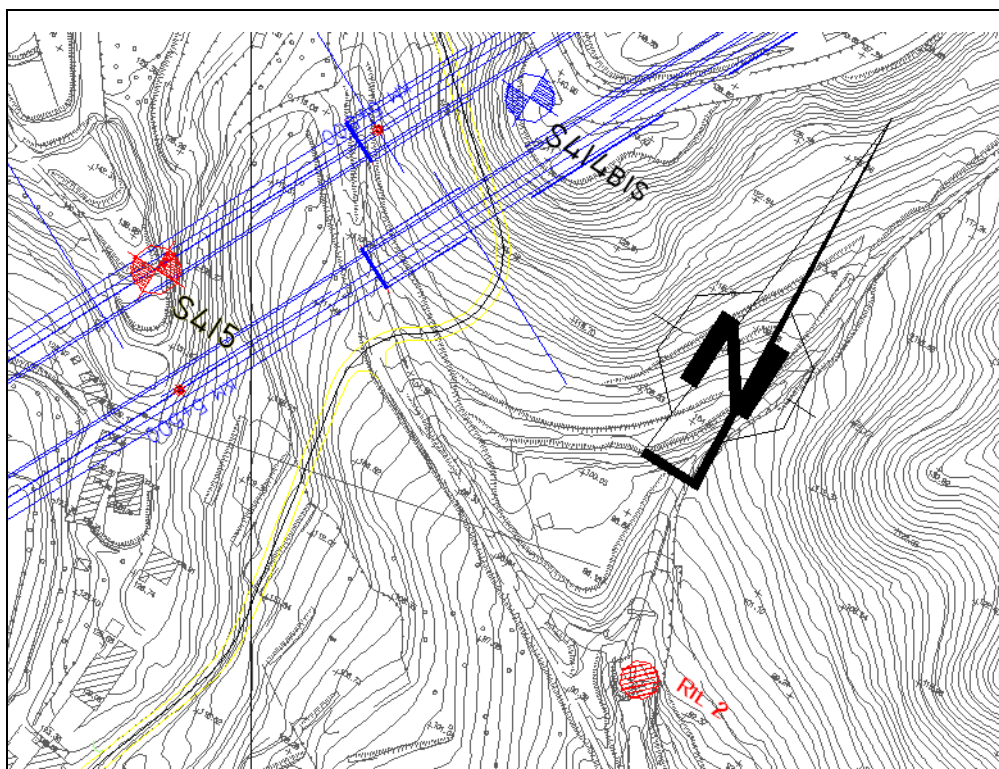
Ubicazione in planimetria dell'affioramento oggetto del rilievo geostrutturale
